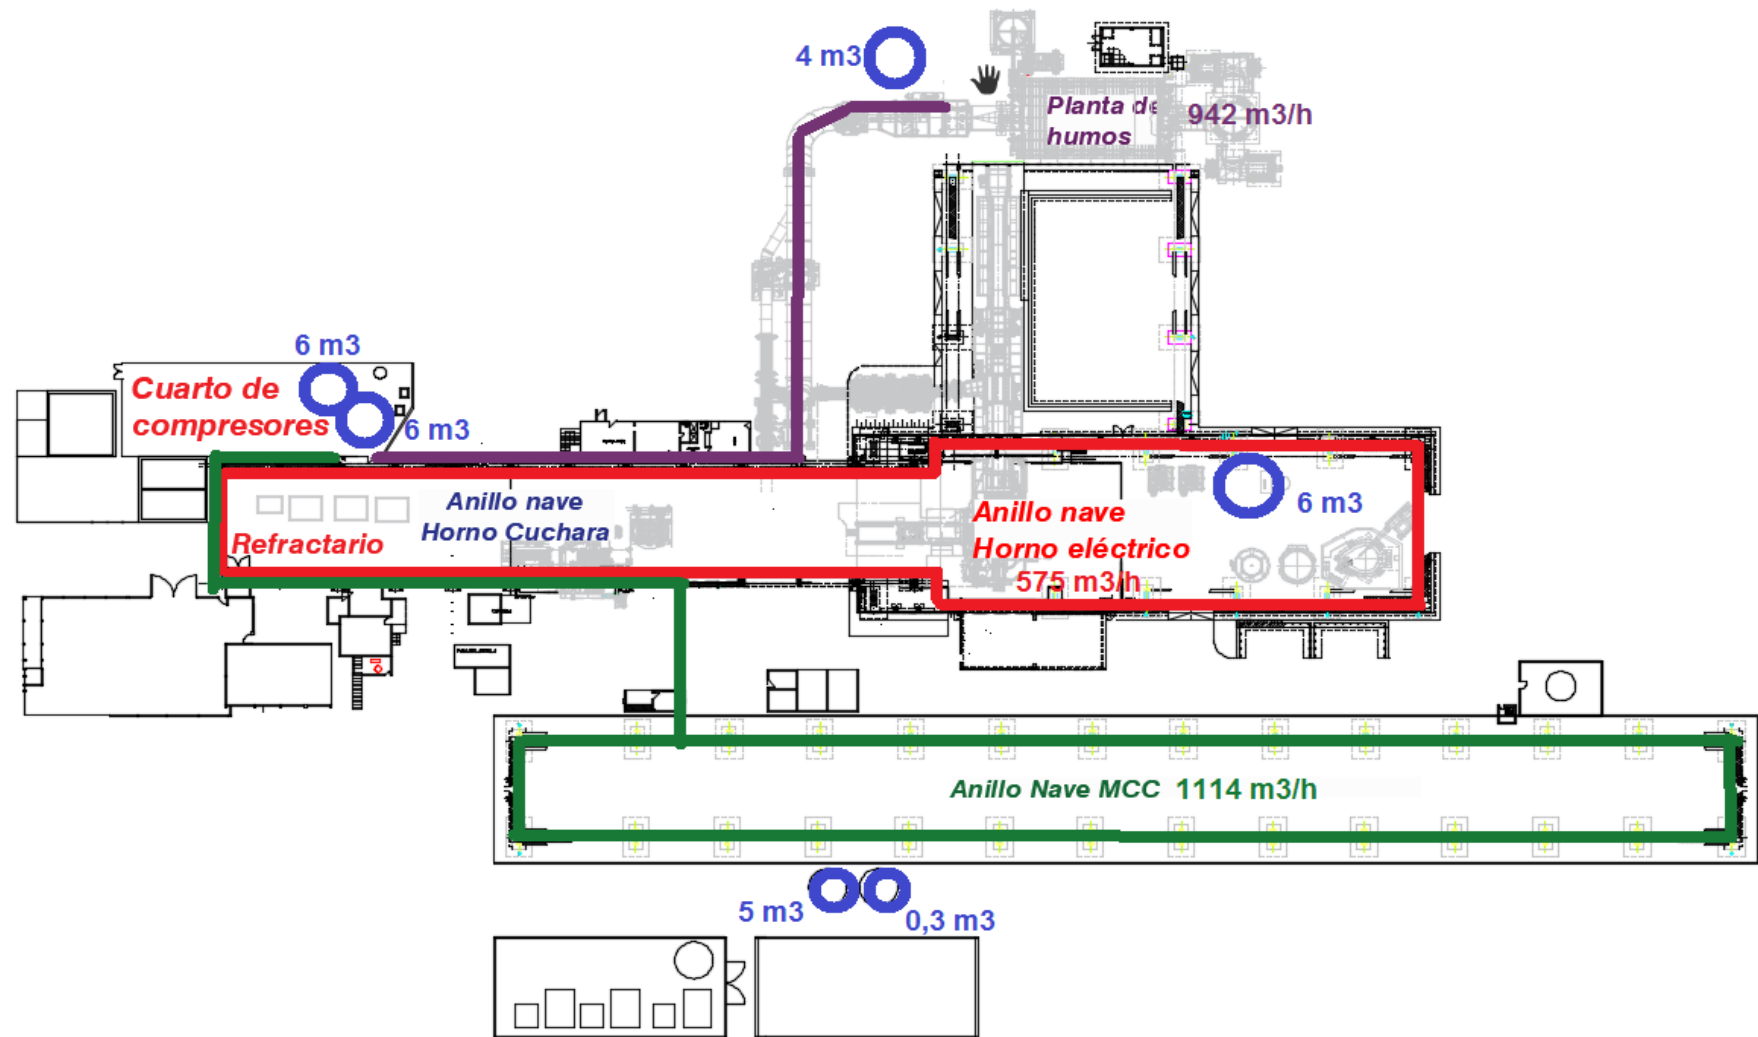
Layout del sistema de aire comprimido para la Planta de Acería de ANDEC S.A.
